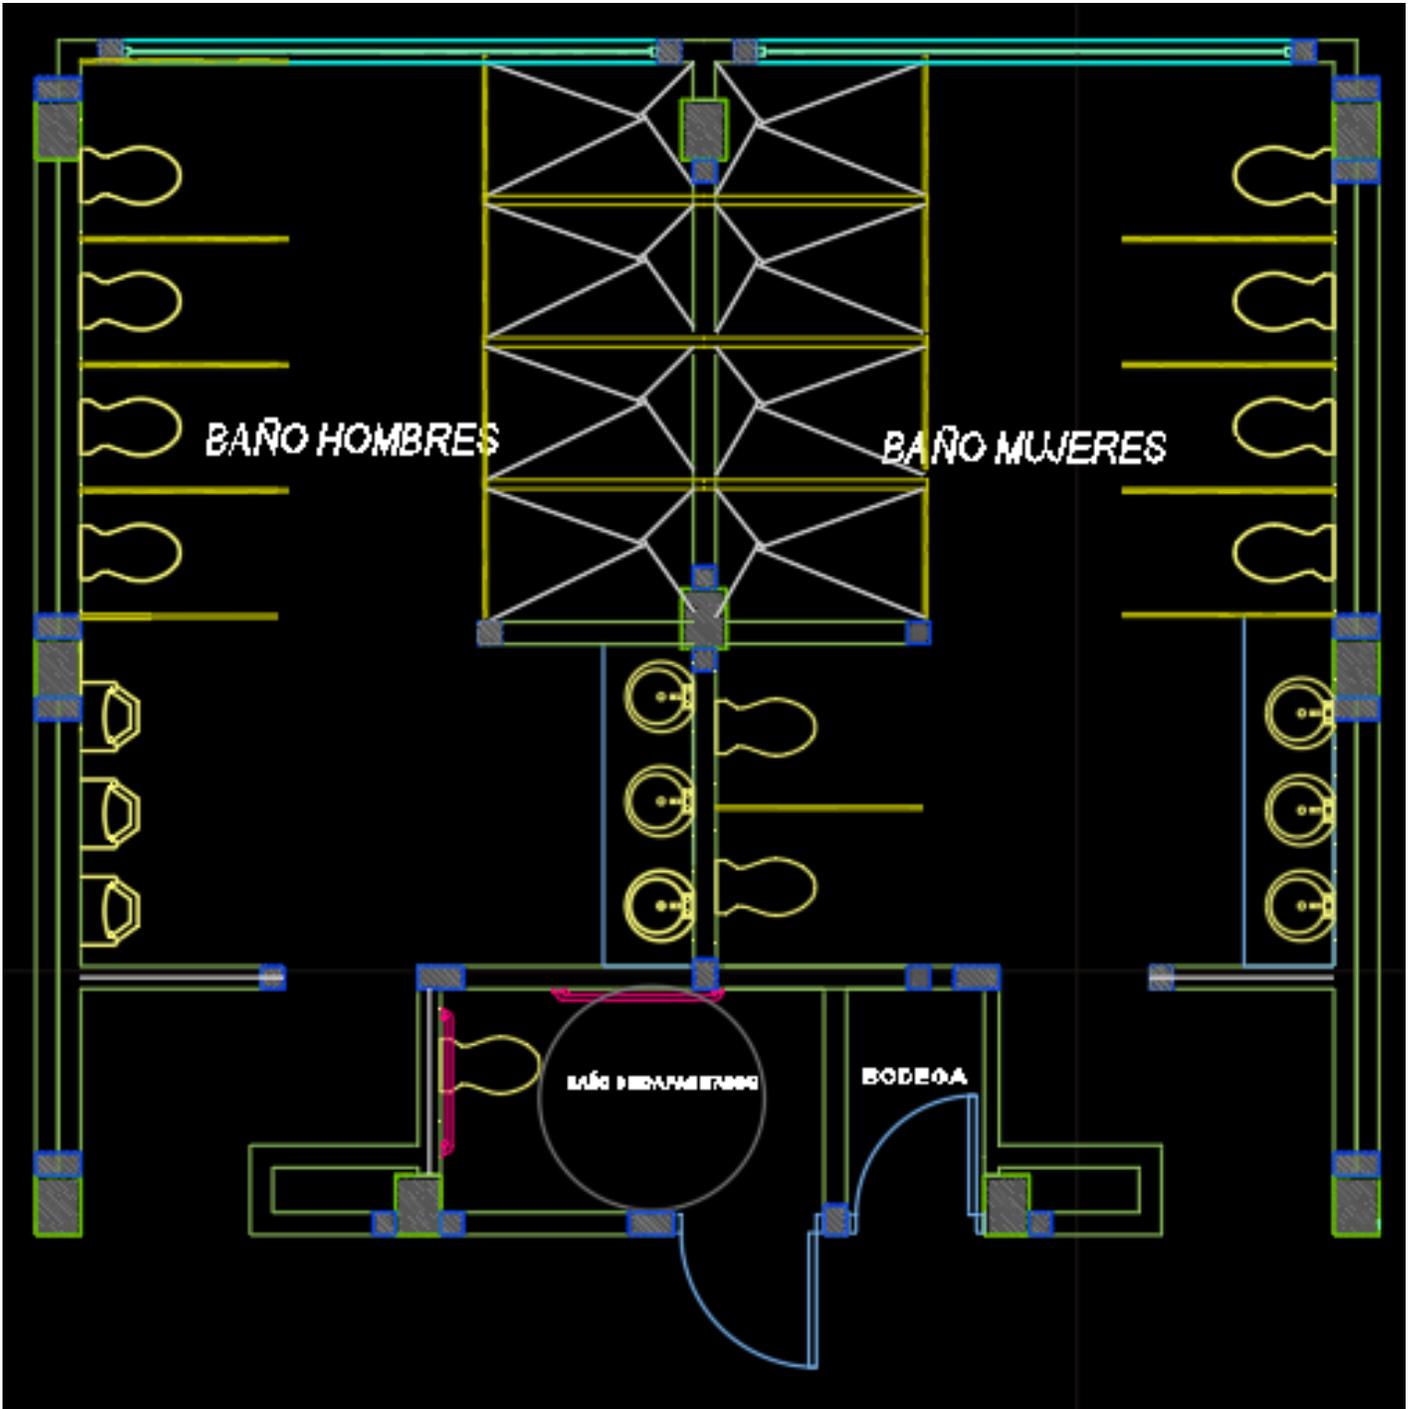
Plano planta de baños bloque educativo 2da versión, Planos Camilo Torres
